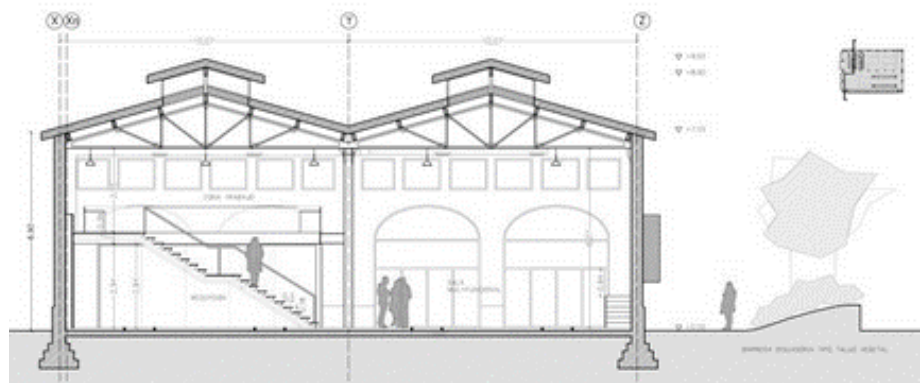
Corte transversal 02 del de antiguo edificio de León - España.
